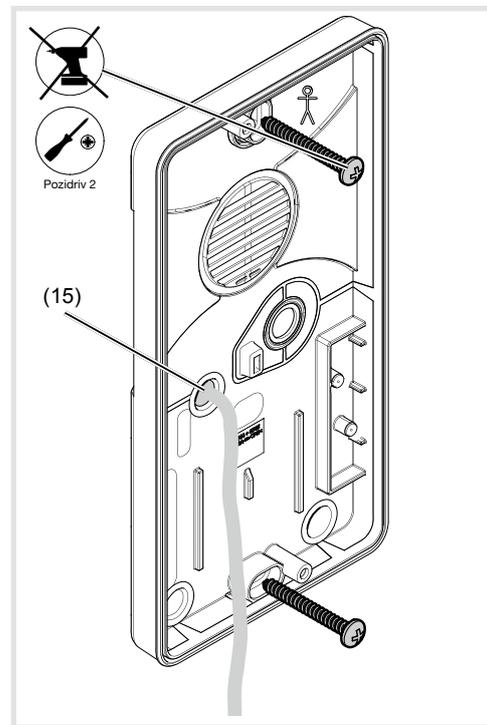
Befestigung der Sockelplatte (15) Kabeldurchführung
